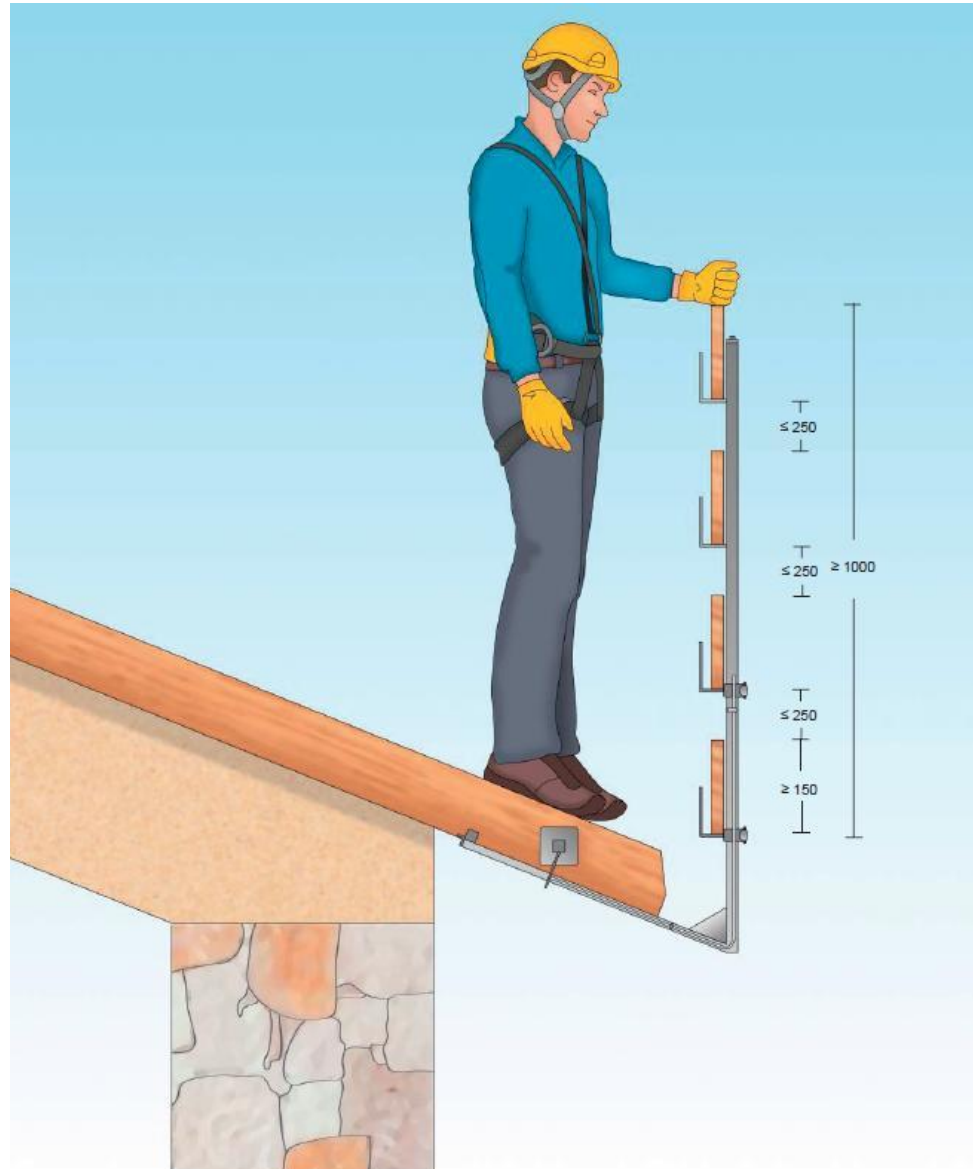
Requisiti geometrici di un parapetto provvisorio di classe B secondo la UNI EN 13374 (misure in mm)
